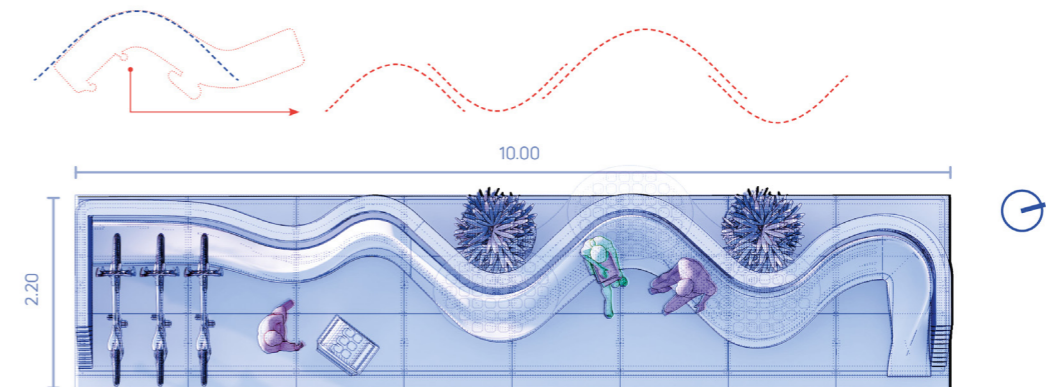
Acima: extração da curva a partir da planta baixa do edifício copan; abaixo: planta de layout mobiliário da proposta. Fonte: autoria própria, 2020.
